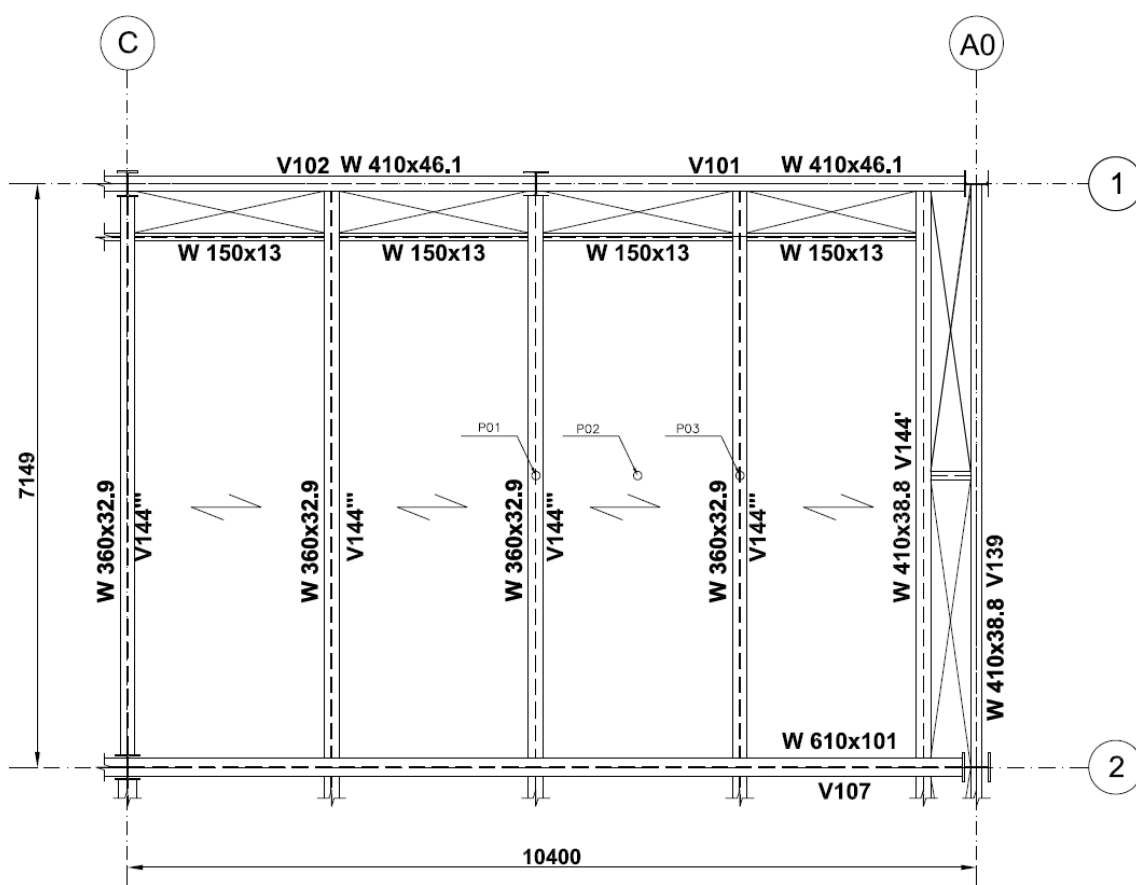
Plano das vigas da região crítica e posicionamento dos acelerômetros.
